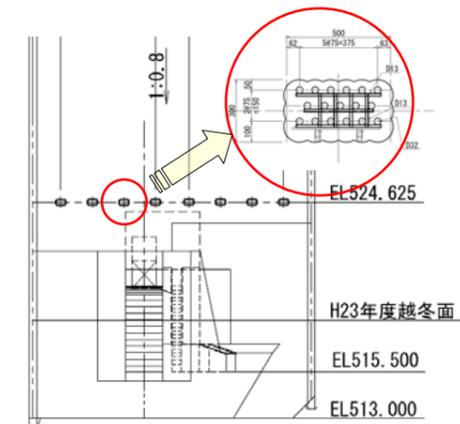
対策② 上下流補強鉄筋工 配筋概要図
